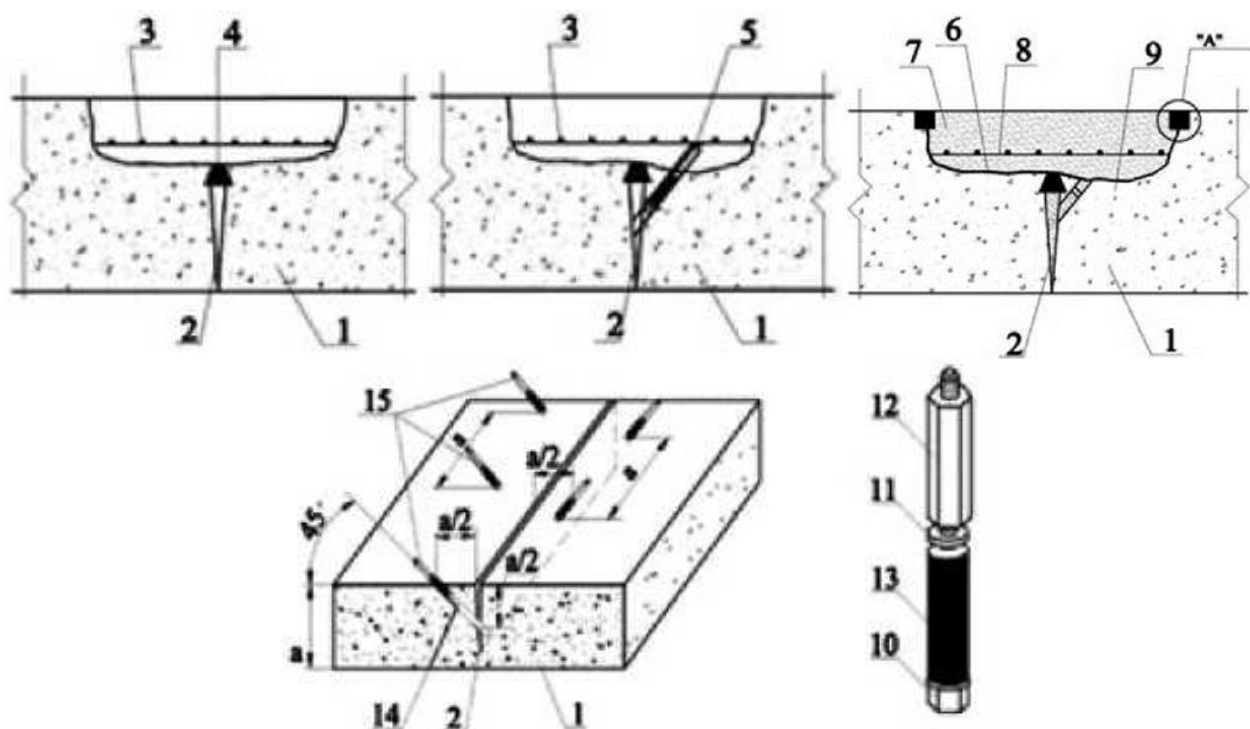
Тріщини в монолітній залізобетонній фундаментній плиті. Усунення водонепроникності плити
